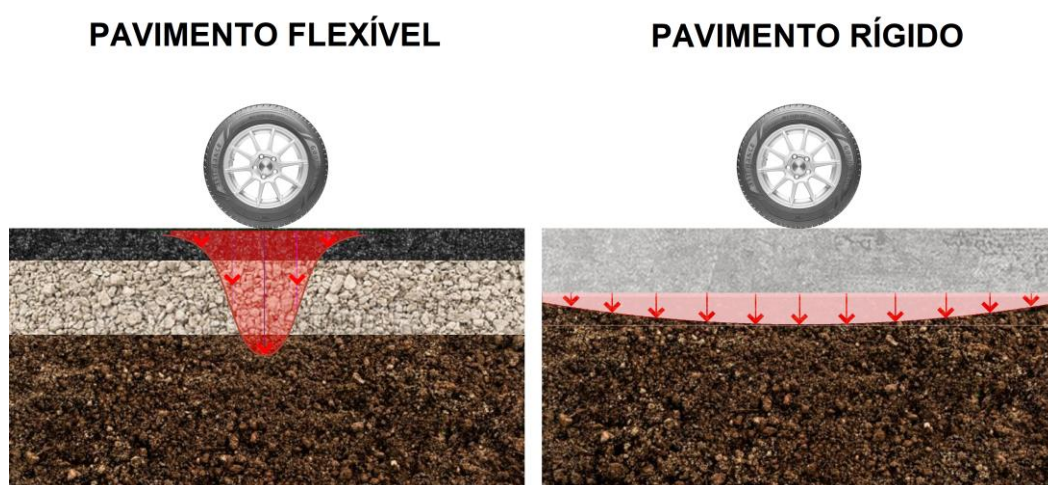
Distribuição de Cargas em um pavimento flexível e rígido.
